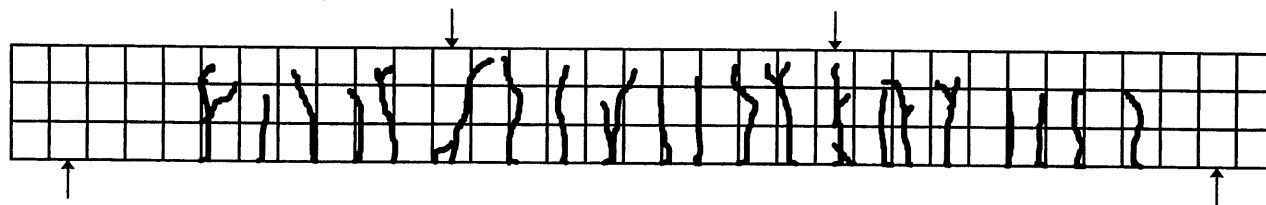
Réseau de fissuration de la dalle SC150OA
